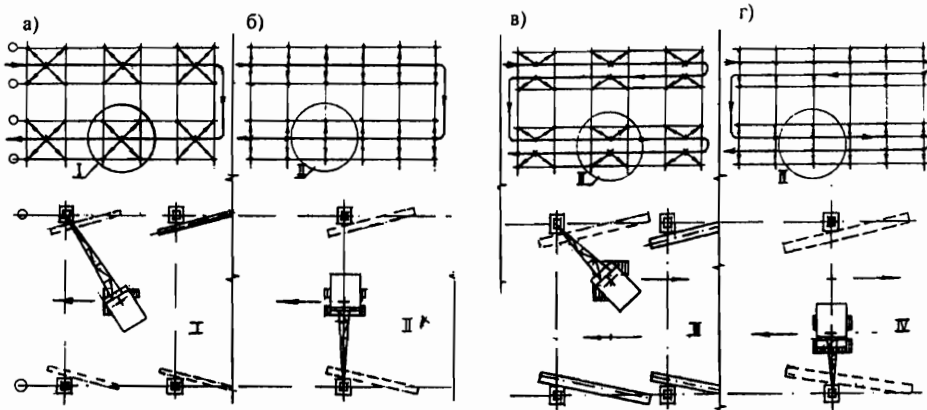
Схемы раскладки и монтажа колонн: а, б - при осевой проходке крана; в, г - при смещенной проходке
